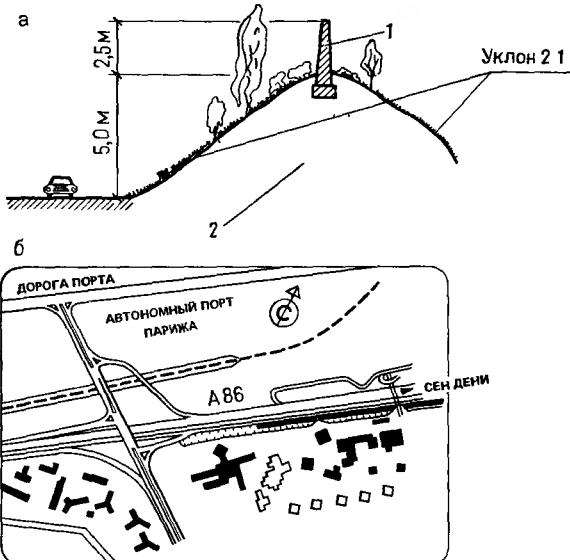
Поперечный разрез шумозащитного экрана из бетонных блоков с земляным ядром
